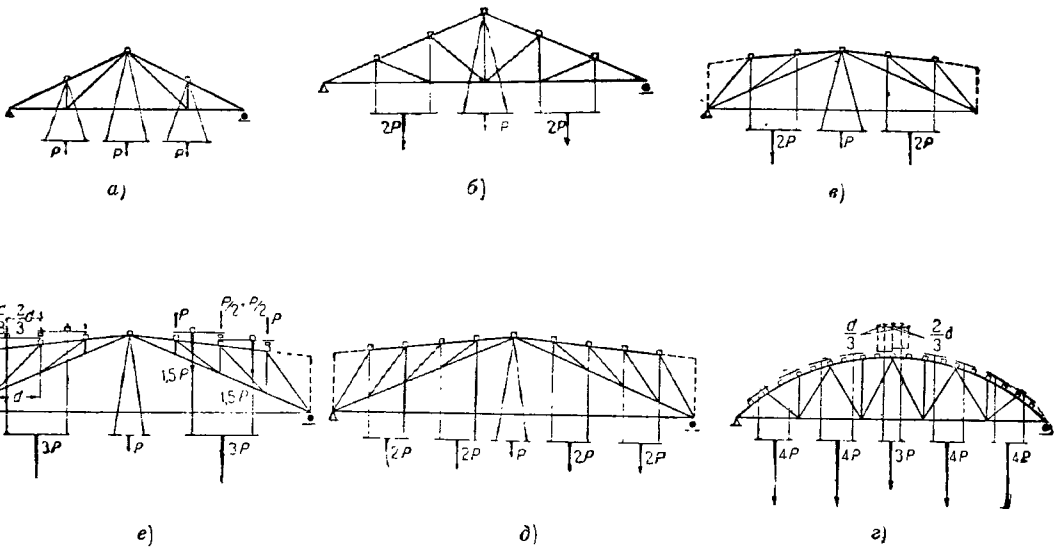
Схема подвесной платформы при передаче нагрузки на одну ферму
